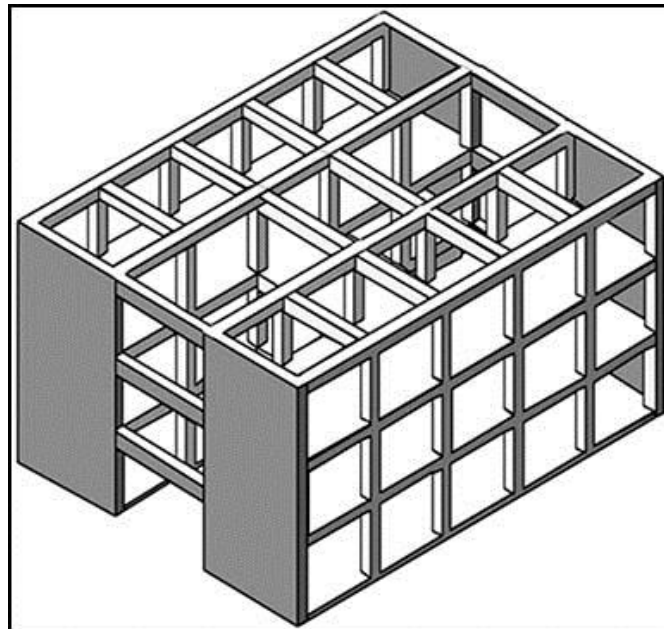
Muros ubicados en el exterior de la estructura.³²
